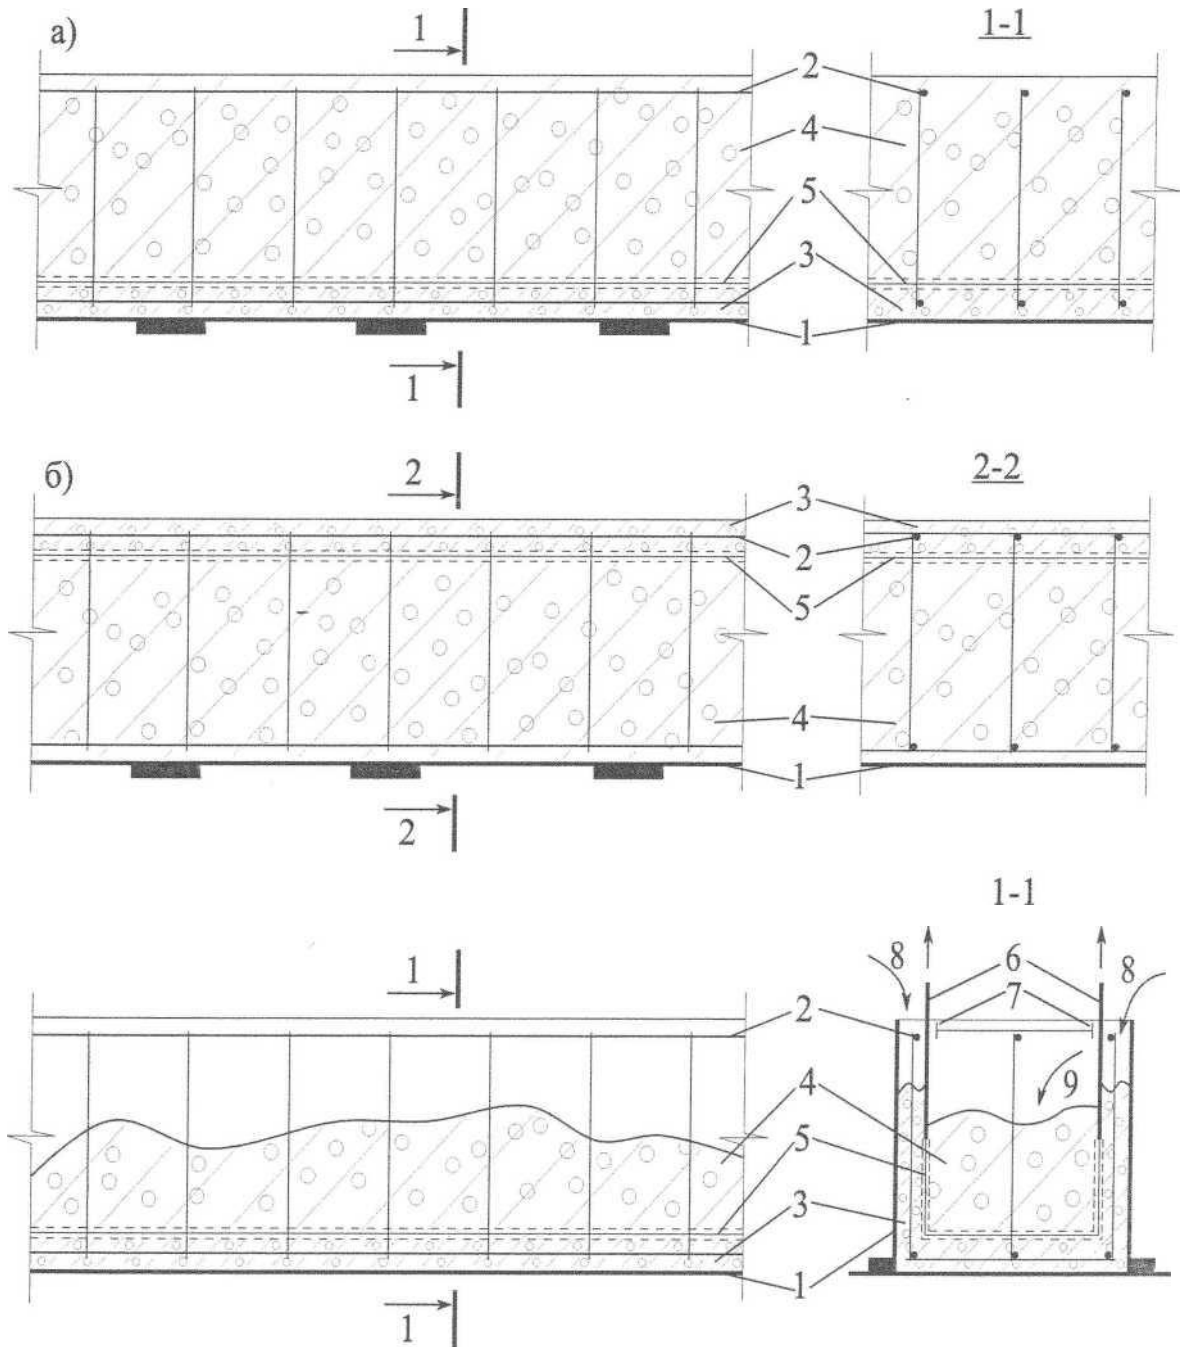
Схема бетонування несучої залізобетонної балки
